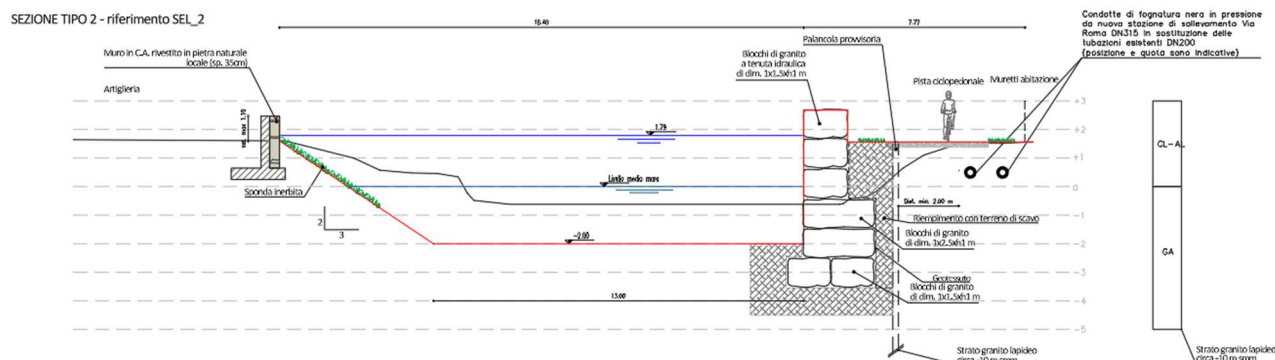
sezione di progetto nel tratto di foce del riu Seligheddu con muretto di protezione lato Artiglieria e muro a parete verticale in blocchi di granito in dx)
